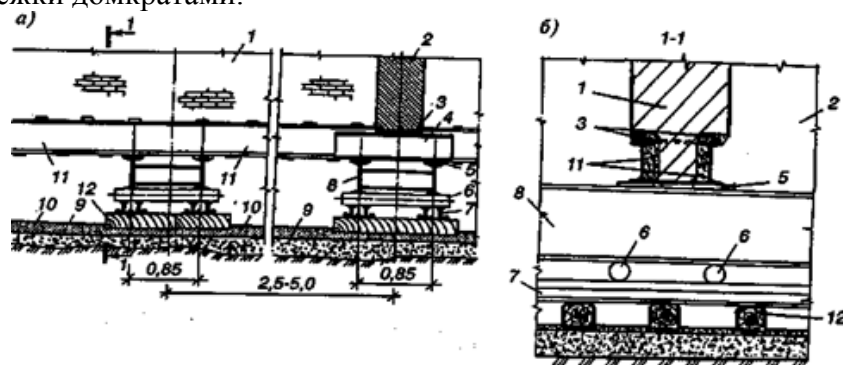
Опорные конструкции, воспринимающие нагрузку от здания. Вид на стену, идущую поперек направления перемещения:
